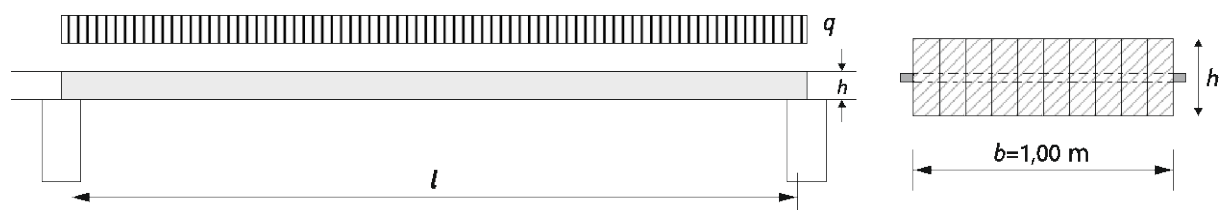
Esquema del entrepiso en análisis: vista en corte y sección transversal.
